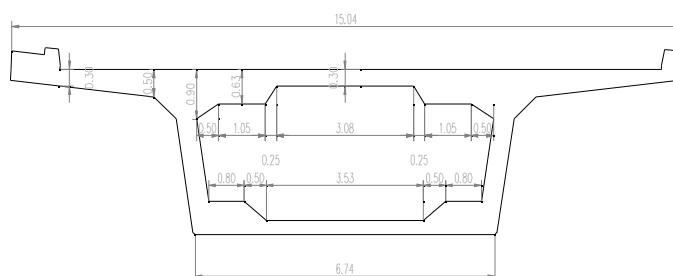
Corte transversal do tabuleiro na zona dos encontros e na secção média dos vãos maiores.
